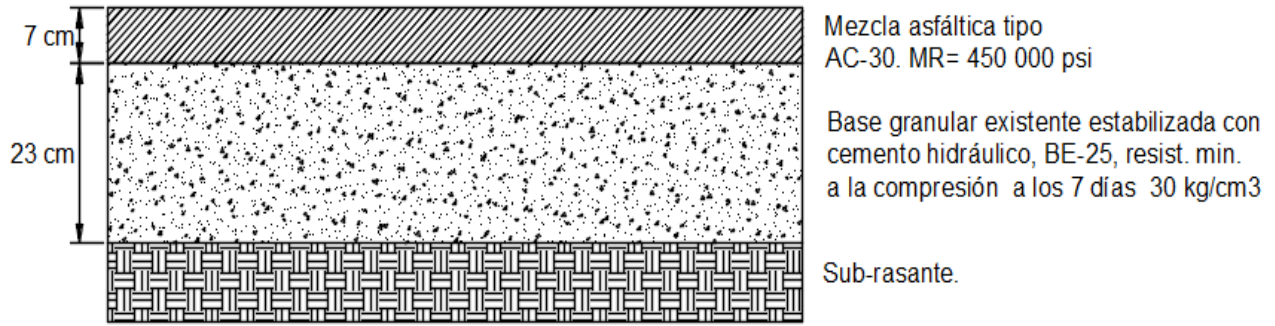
Perfil de la estructura de pavimento propuesta para el TH=33.
